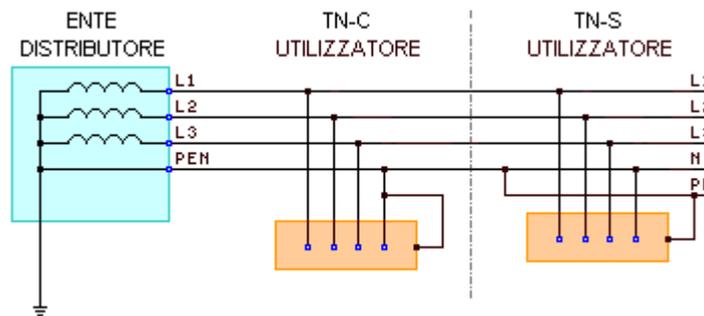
Schema di impianto TN con divisione tra TN-C e TN-S
